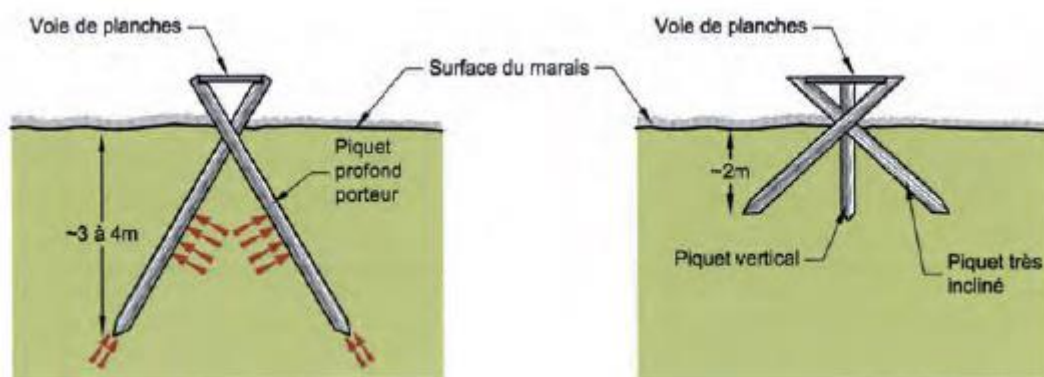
Fondation de voies néolithiques (Angleterre).[12]
